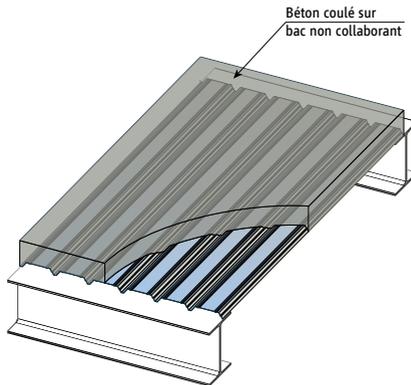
Exemple de dalle béton avec coffrage métallique perdu (Cofrasol 40)
